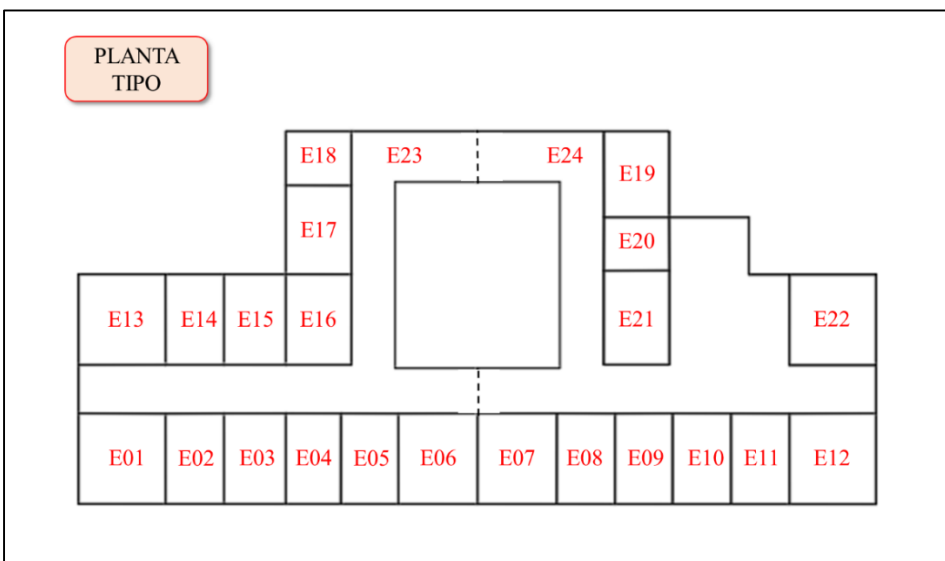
Zonificación de las plantas 1, 2, 3 y 4 (planta tipo). Fuente: Elaboración propia.
